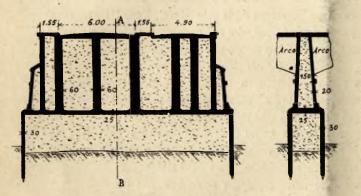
Sezione long, di una pila, proiettata su di un piano normale all'asse del ponte.
